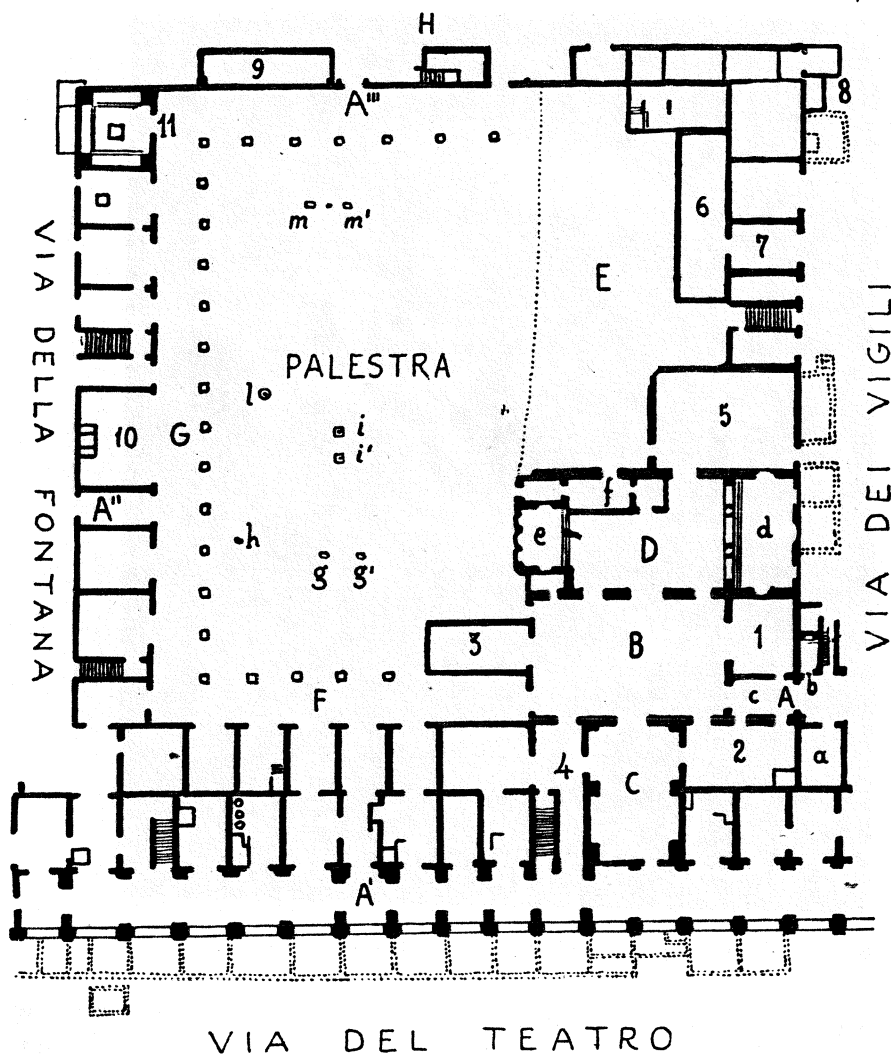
bis. - Pianta delle Terme (Scavi 1888, 1909-1911).
